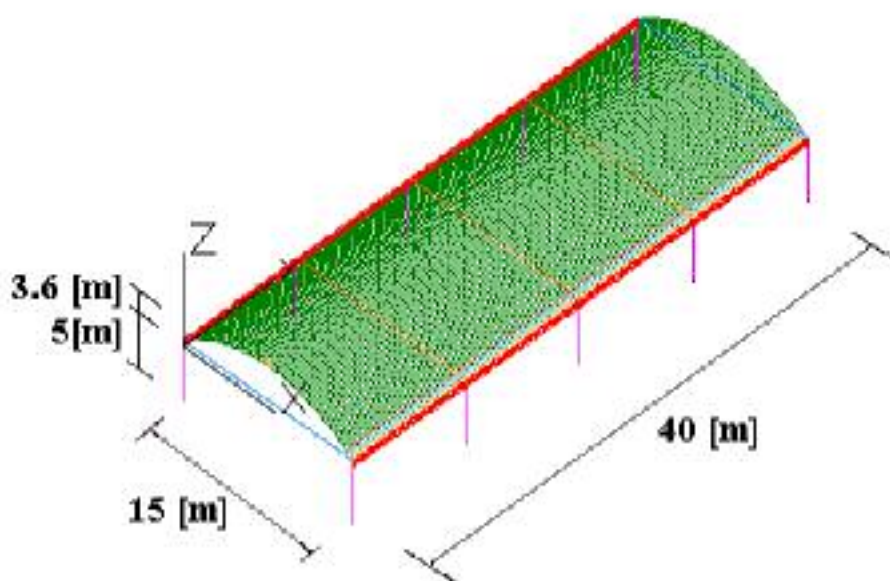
Modelo de la estructura laminar cilindro-parabólica de hormigón armado
